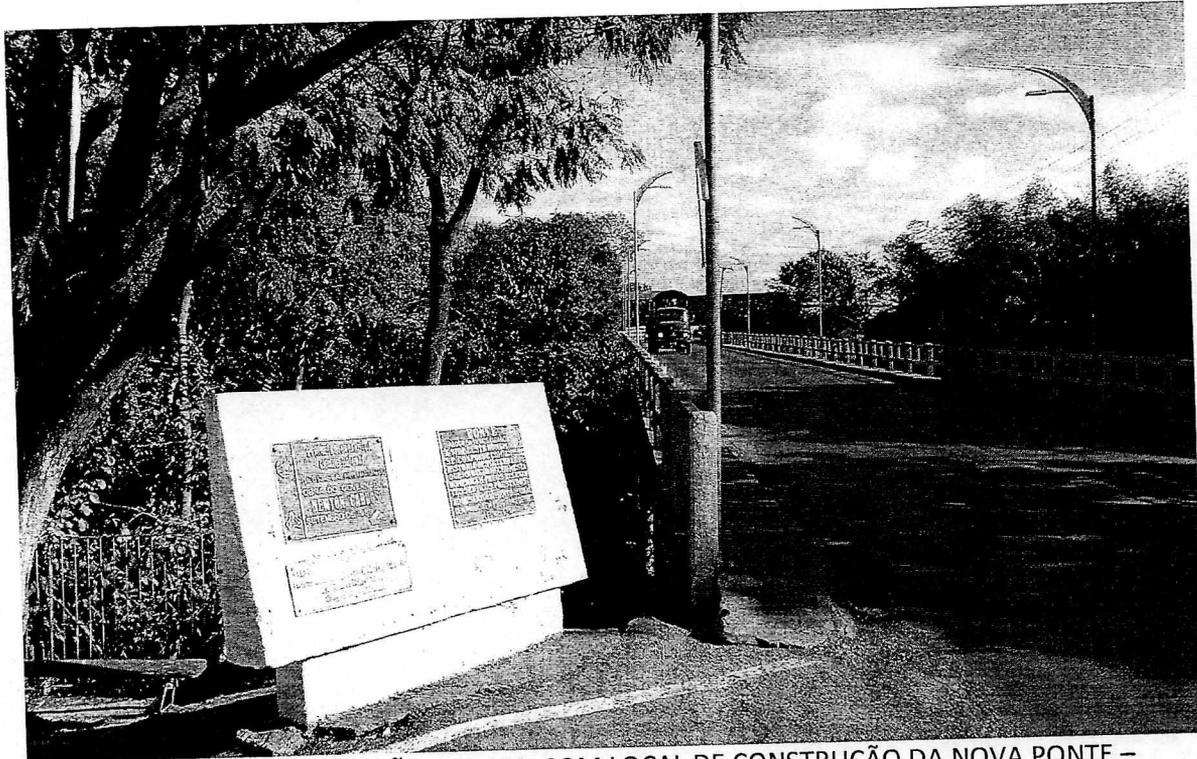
INÍCIO DA DUPLICAÇÃO MG 188, COM LOCAL DE CONSTRUÇÃO DA NOVA PONTE – 24/08/2017
